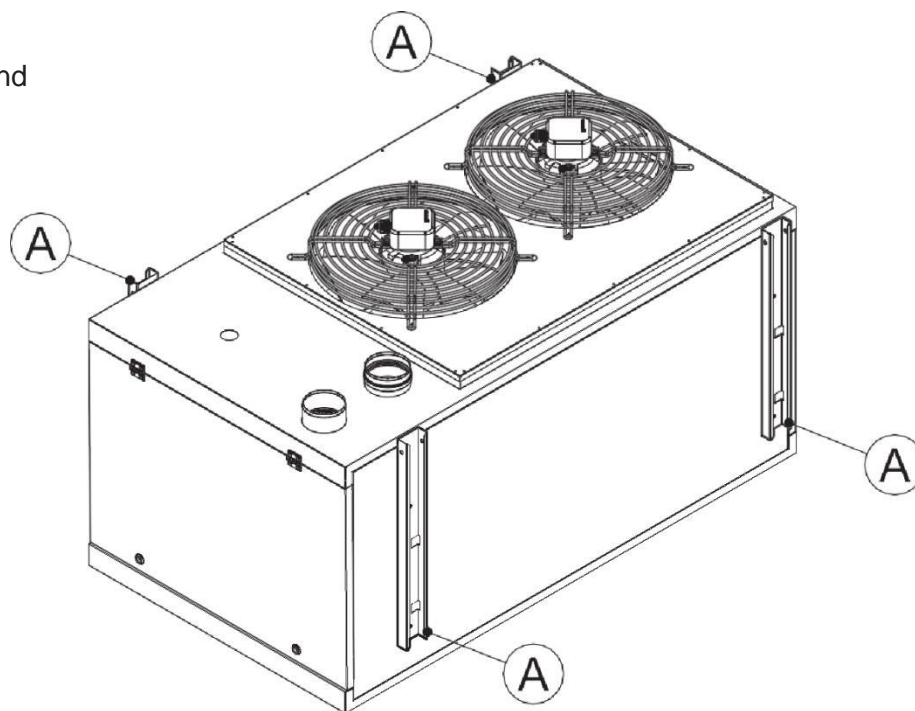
Appareils conçus pour une installation suspendue au plafond
